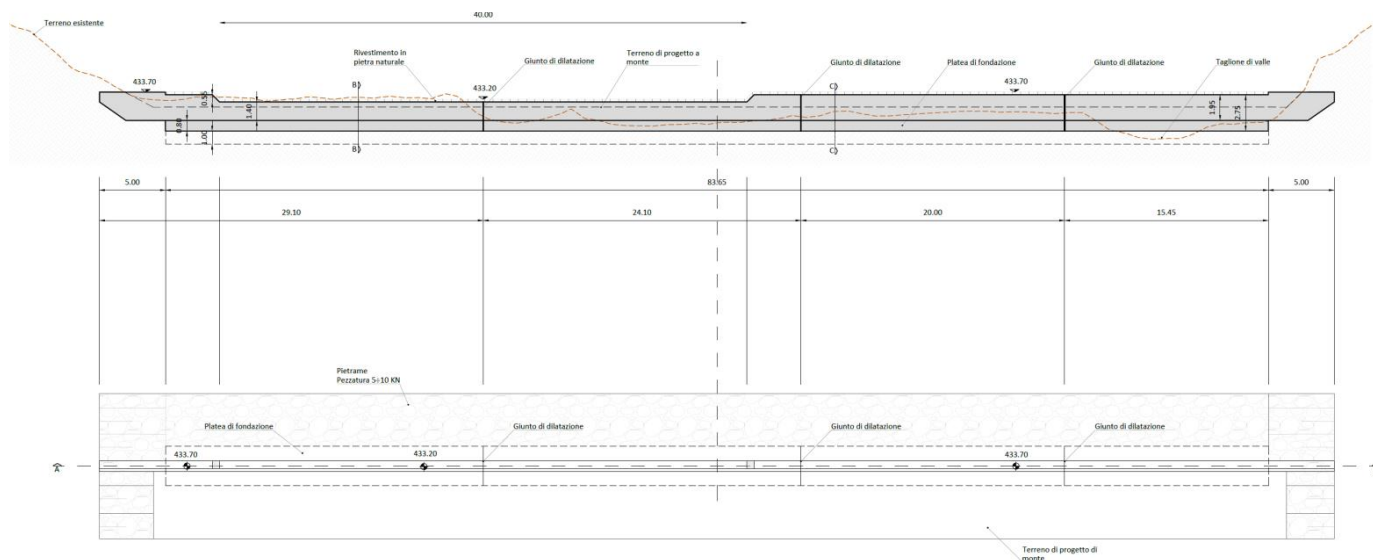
Esemio di briglia rettilinea: briglia di monte M\_2. Prospetto (in alto) e planimetria (in basso).
